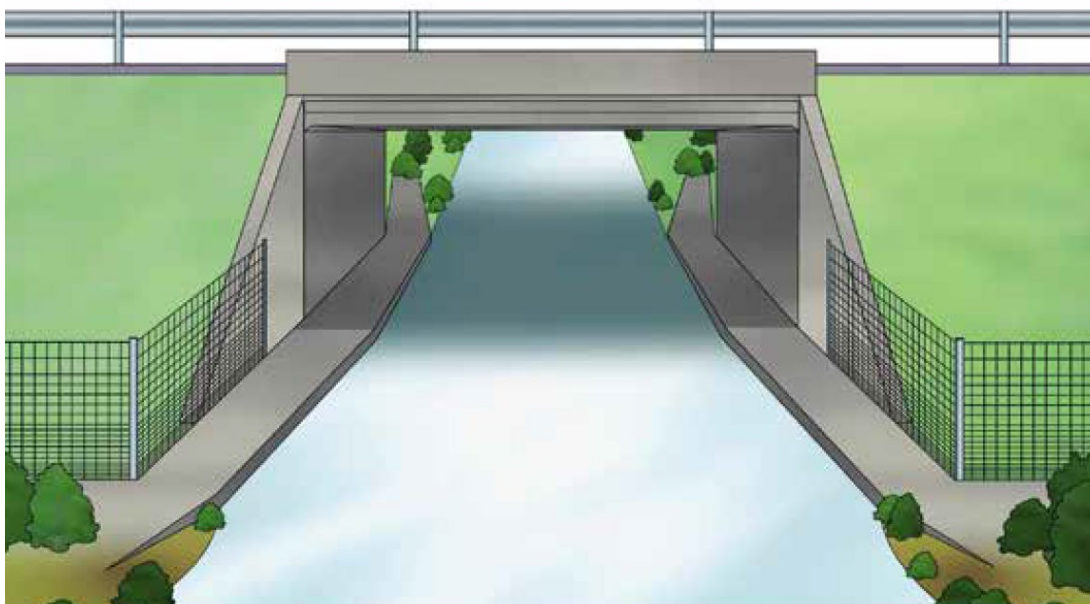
17. Esquema de cajón modificado para paso de fauna con rampas de acceso y cierre perimetral.
